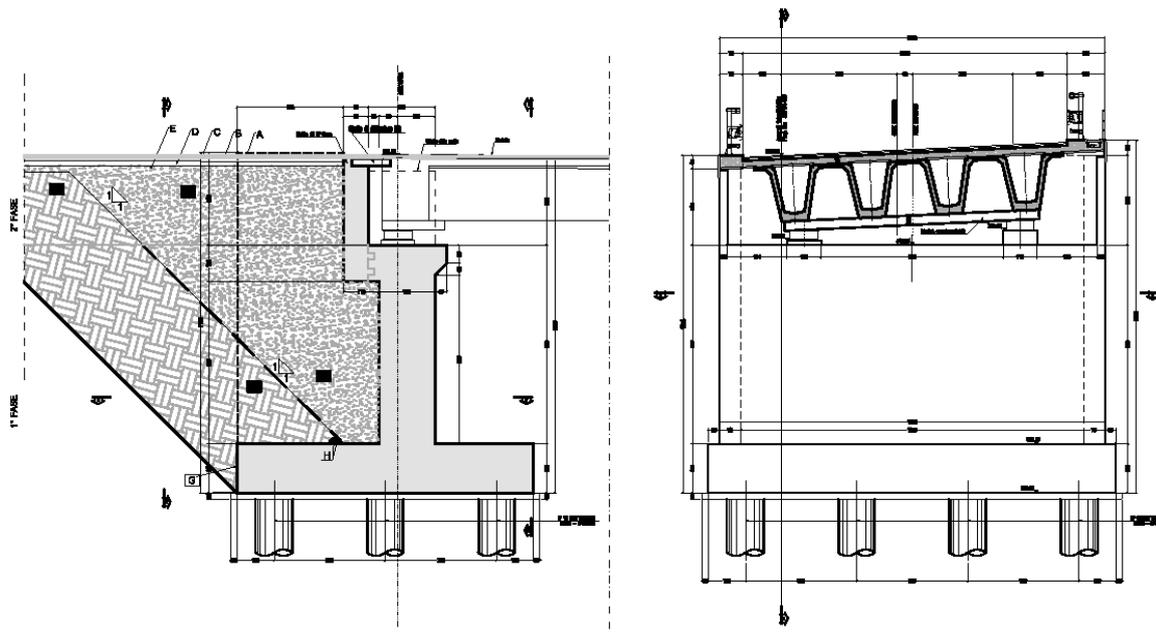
Sezione longitudinale SpA_SX e Vista frontale SpA_SX
